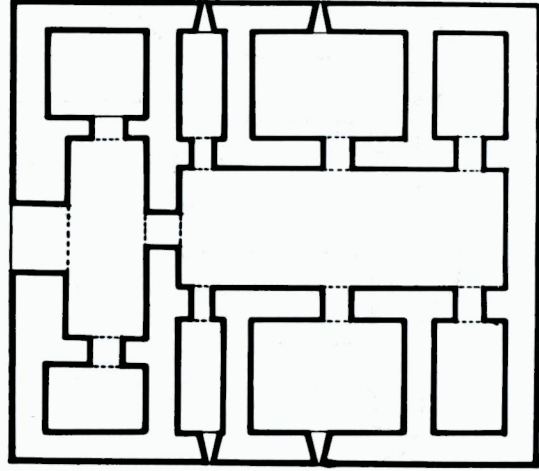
Erkelet, Hızır İlyas Kışku Planı (A. Tükel'den)
